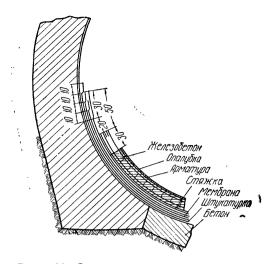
Схема расположения концов покрытия, стяжки, арматуры и бетона при устройстве оклеечной гидроизоляции в нижней части тоннеля
